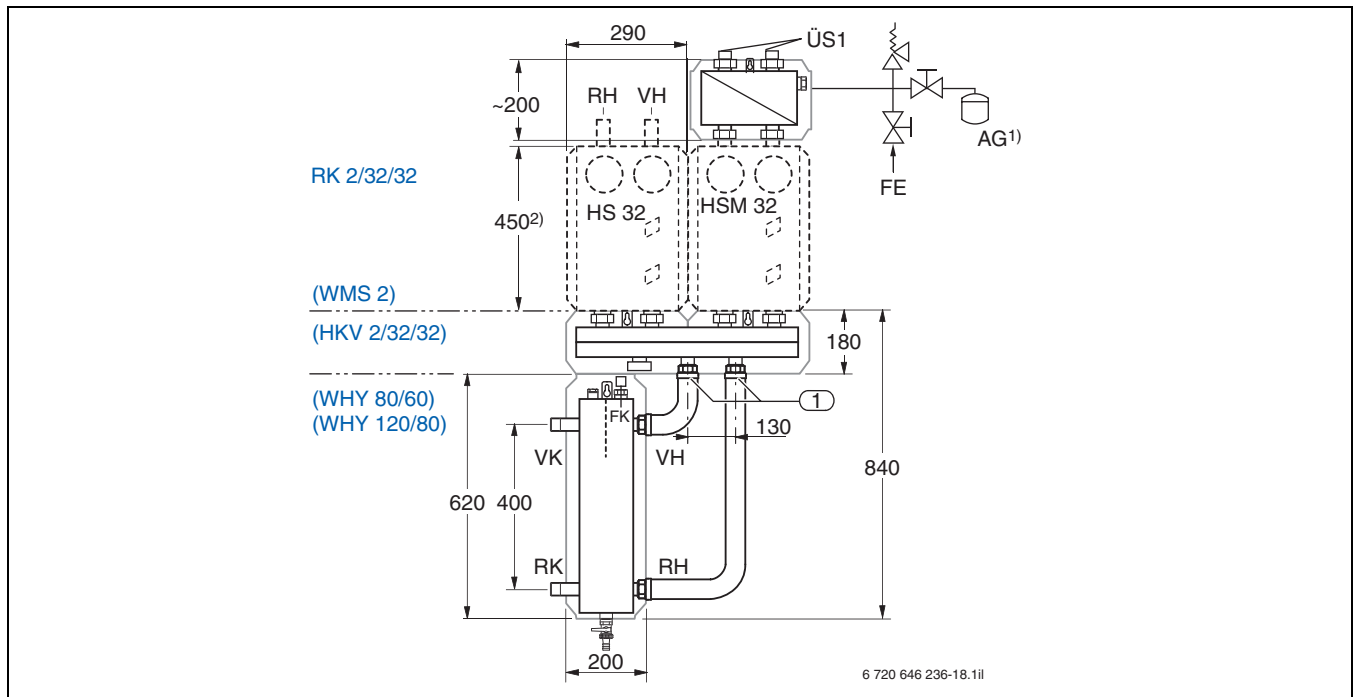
Abmessungen Systemtrennungs-Set mit Bauteilen DN 32 (Maße in mm)
